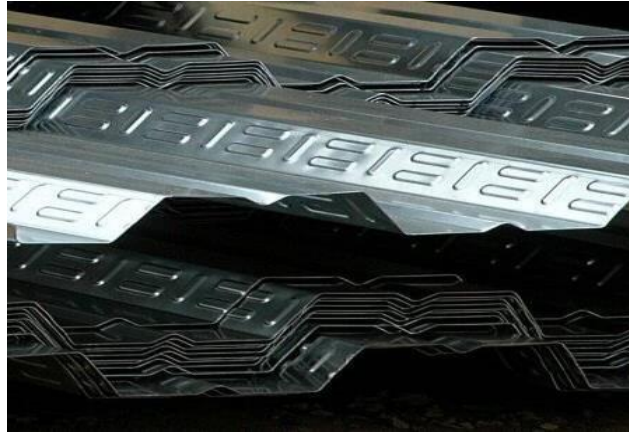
’de kompozit döşemede tercih edilen sac en kesitlerinin bazı örnekleri gösterilmektedir. Ayrıca beton ile çelik sac arasındaki mekanik bağlantıyı sağlayacak olan, beton altı trapez sacın girinti ve çıkıntı boyutları gösterilmektedir. Eurocode 4’de sac için minimum kalınlık 0,70 mm olarak önerilmiştir (CEN 2005c).
